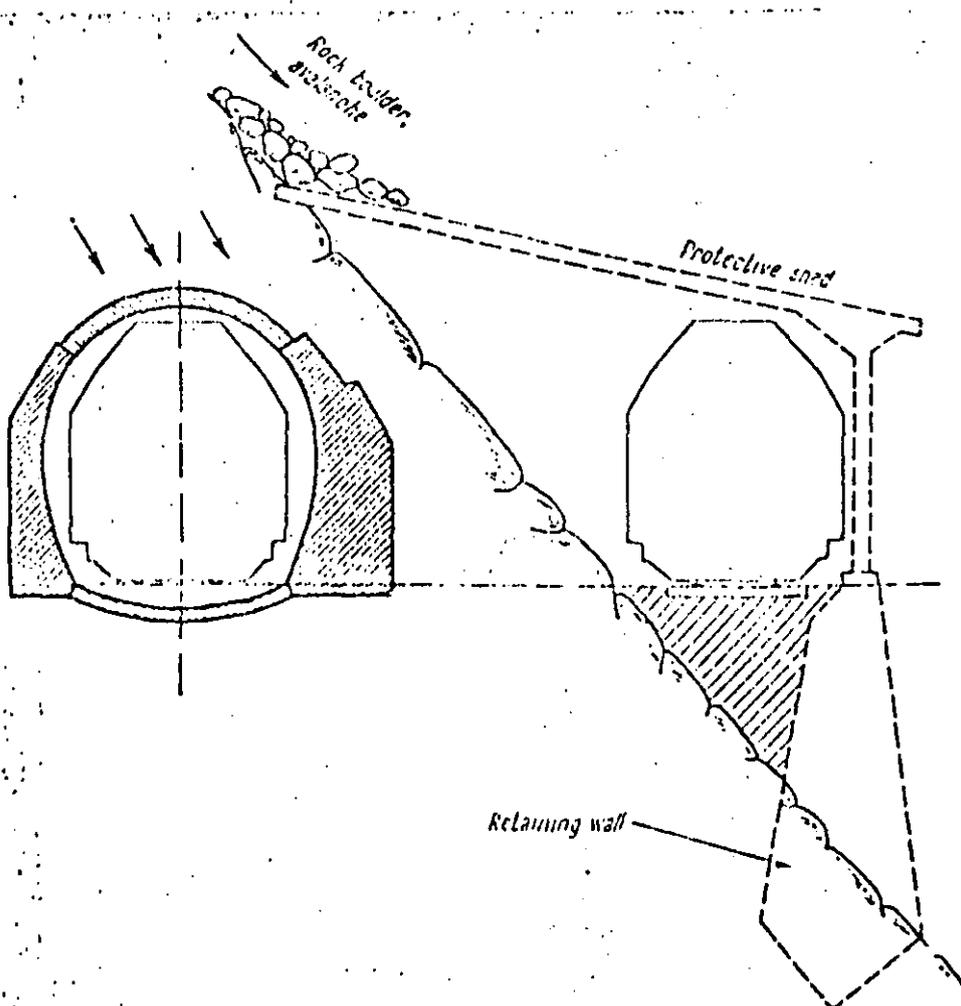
Túneles al pie de ladera inestable (Ref. Szechy)
